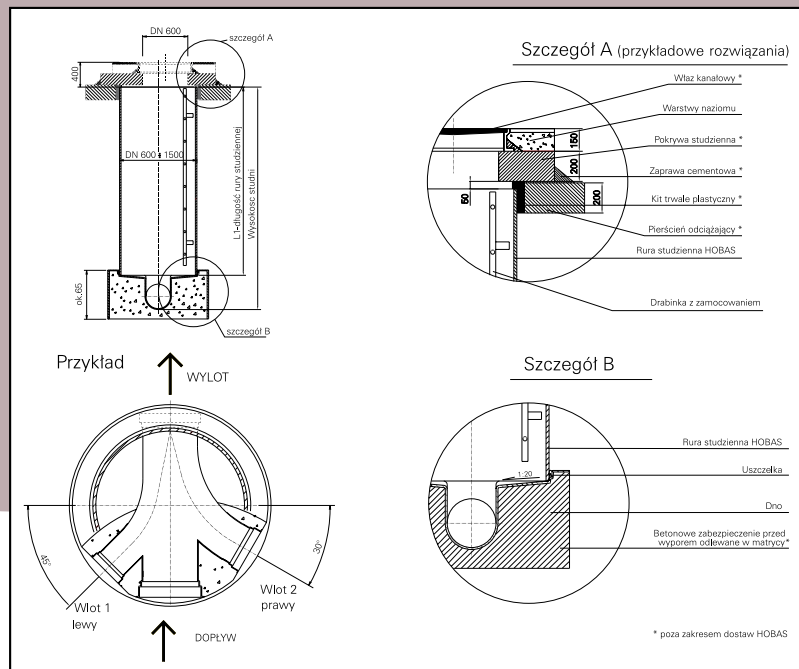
Obetonowanie podstawy studzienki zintegrowanej
